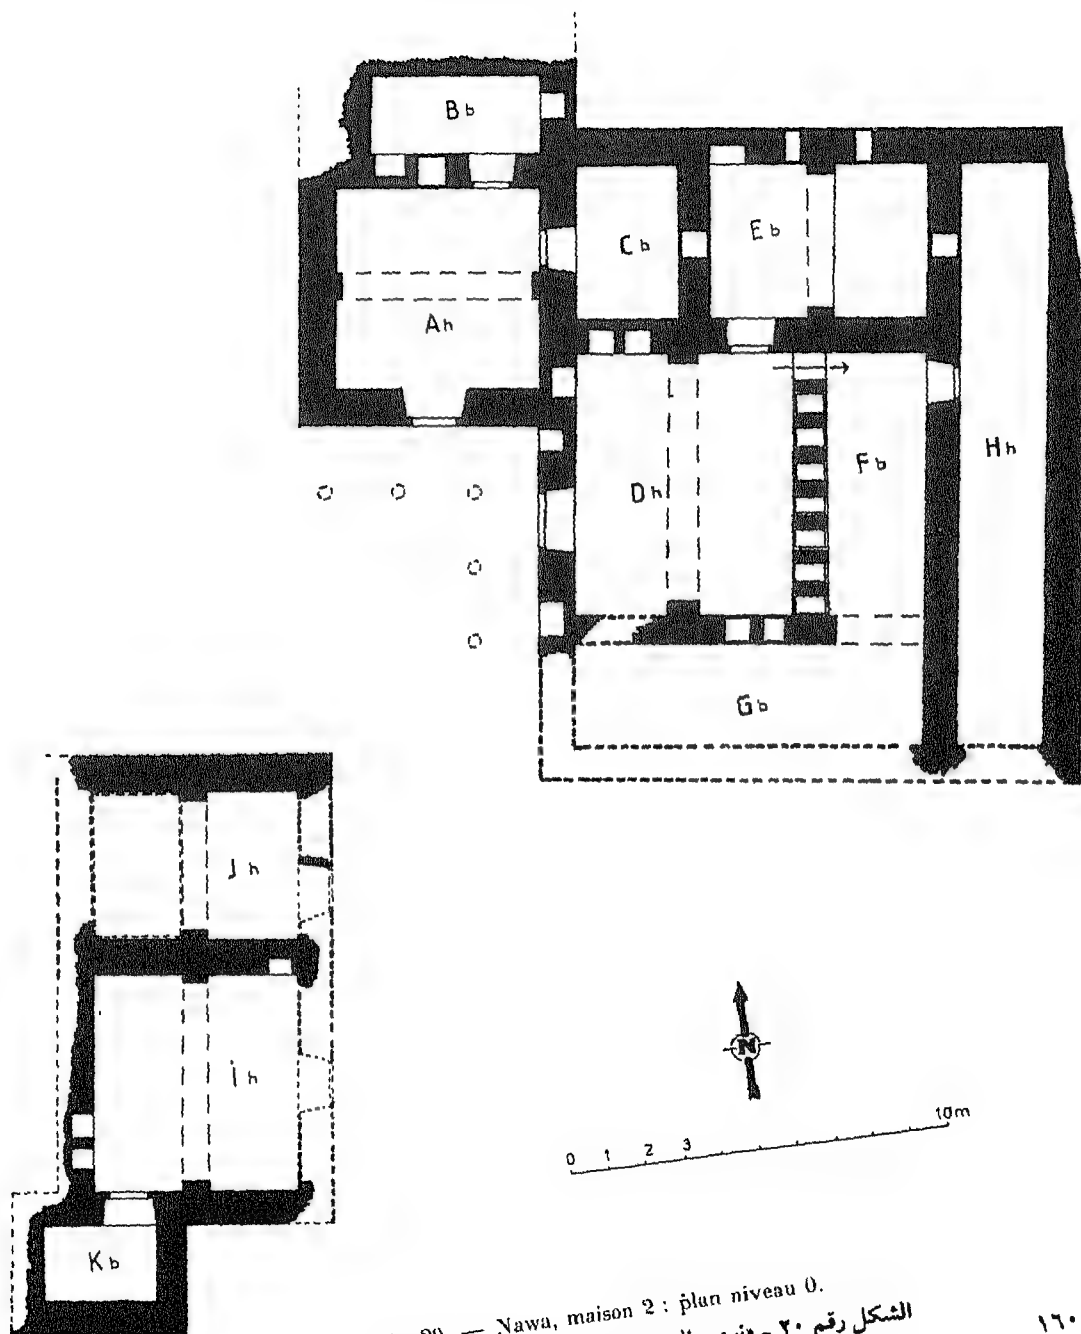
Nawa, maison 2 : plan niveau 0.
